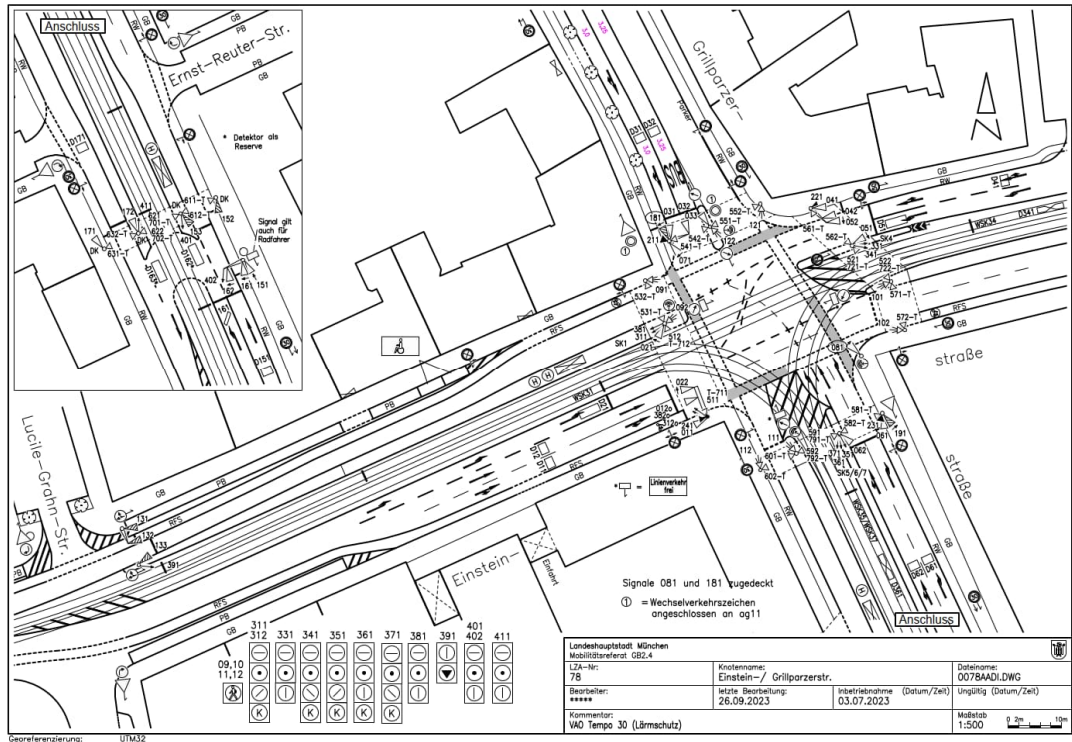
Signallageplan Knotenpunkt Grillparzerstraße / Einsteinstraße (LZA-Nr. 78), [Quelle: LHM]
